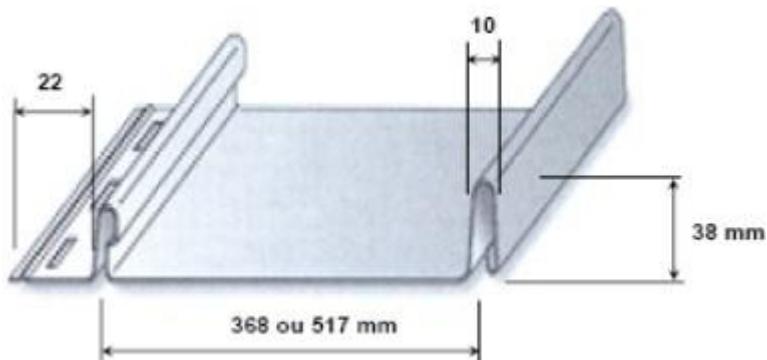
Profils Styl'inov® – Profil n° 3 - joint de 38 mm
